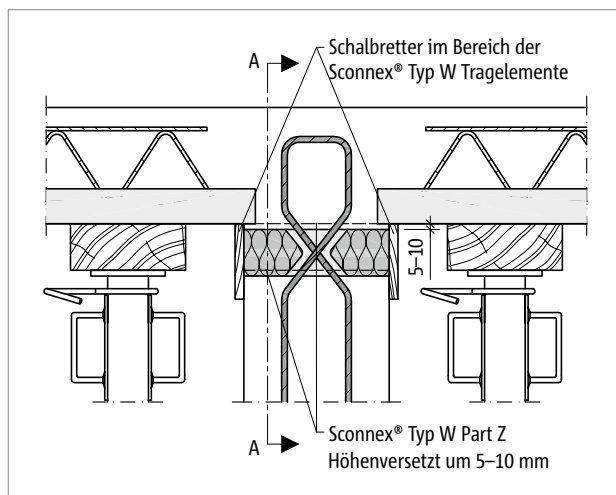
Schöck Sconnex® Typ W: Schematische Darstellung (Einbaustand) Schöck Sconnex® Typ W bei Halbfertigteildecken und Unterdeckendämmung
